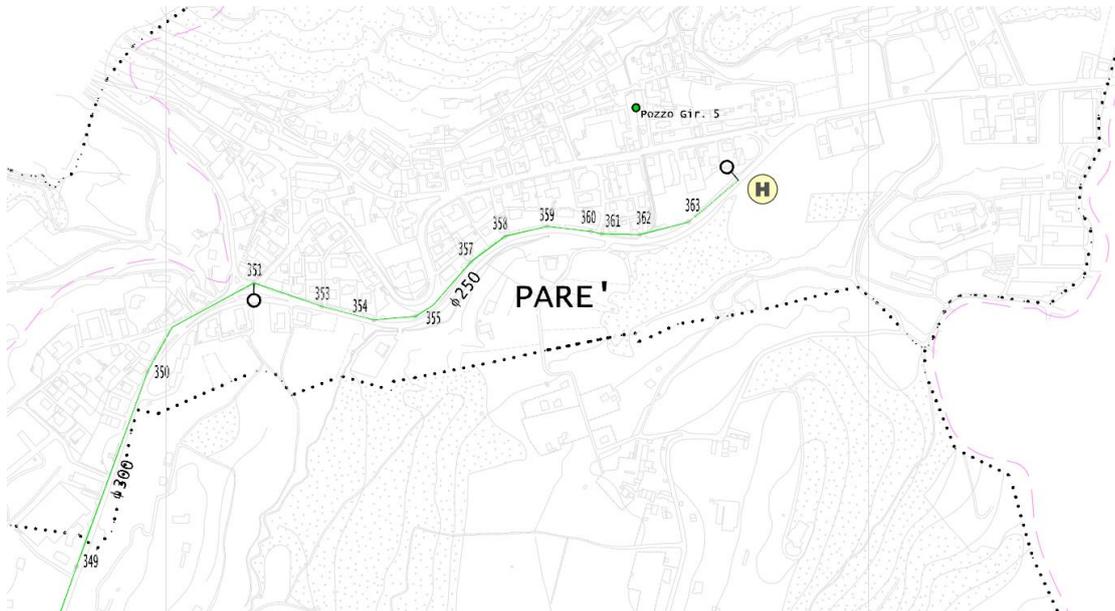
Rifacimento collettore consortile previsto nello studio della rete, zona Parè - da cameretta 360 a 351
